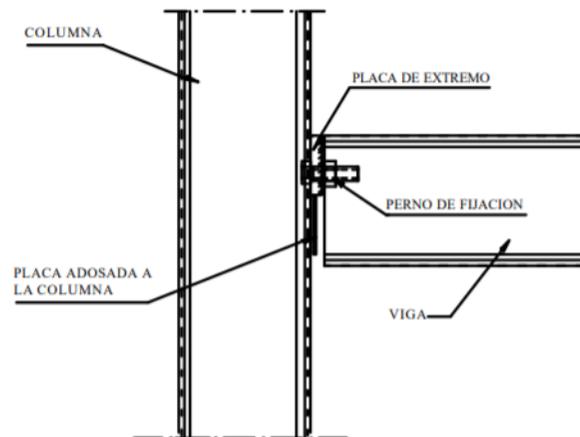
Detalle anclaje de columna con vigas, mediante perno
